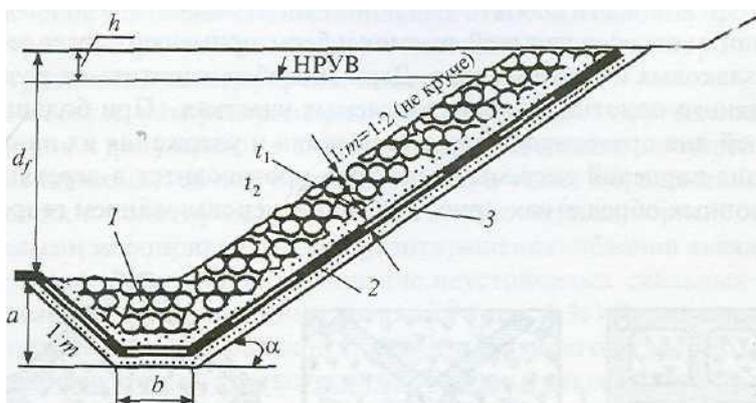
Укрепление откоса поименной насыпи каменной наброской на геотекстиле:
